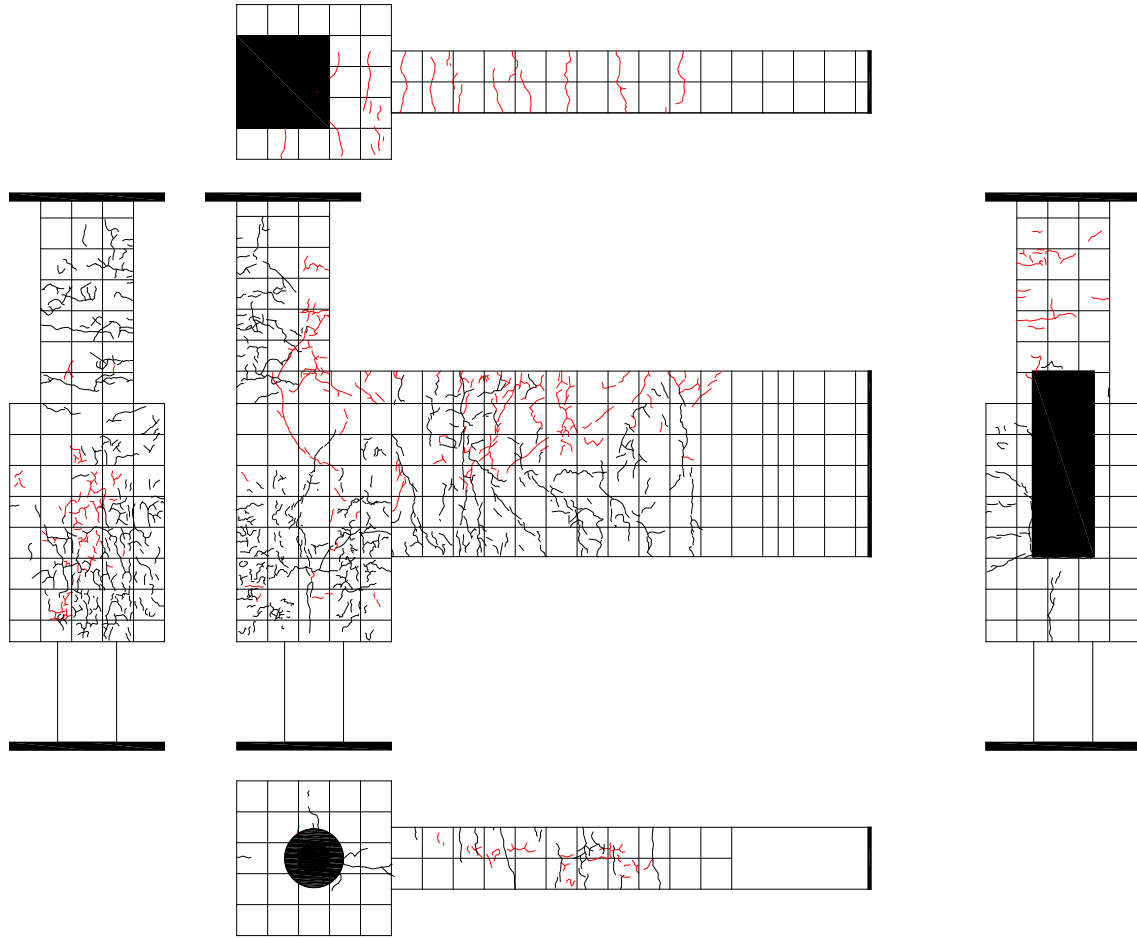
試験体 C-3 ひび割れ状況 (3Cycle)
